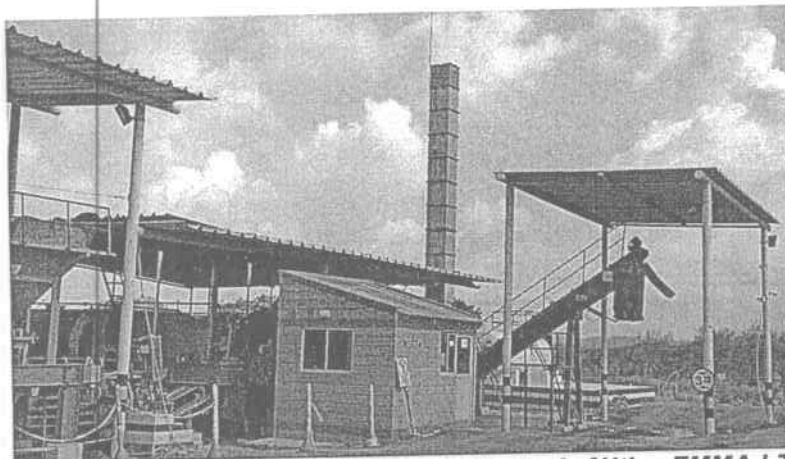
Planta Asfáltica BC 110 IB -EMMA LTDA.
